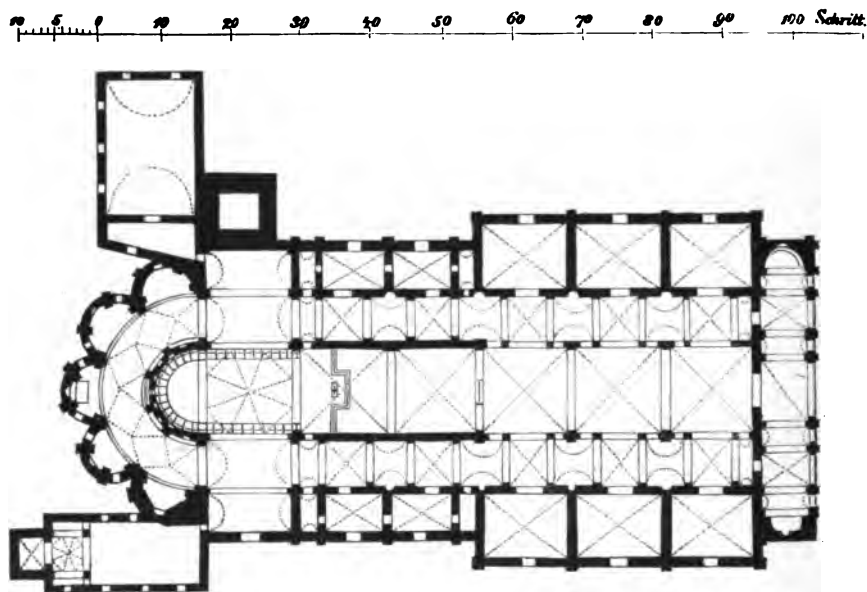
Grundriß der Kirche in S. Benedetto. (M. Lohde.)
